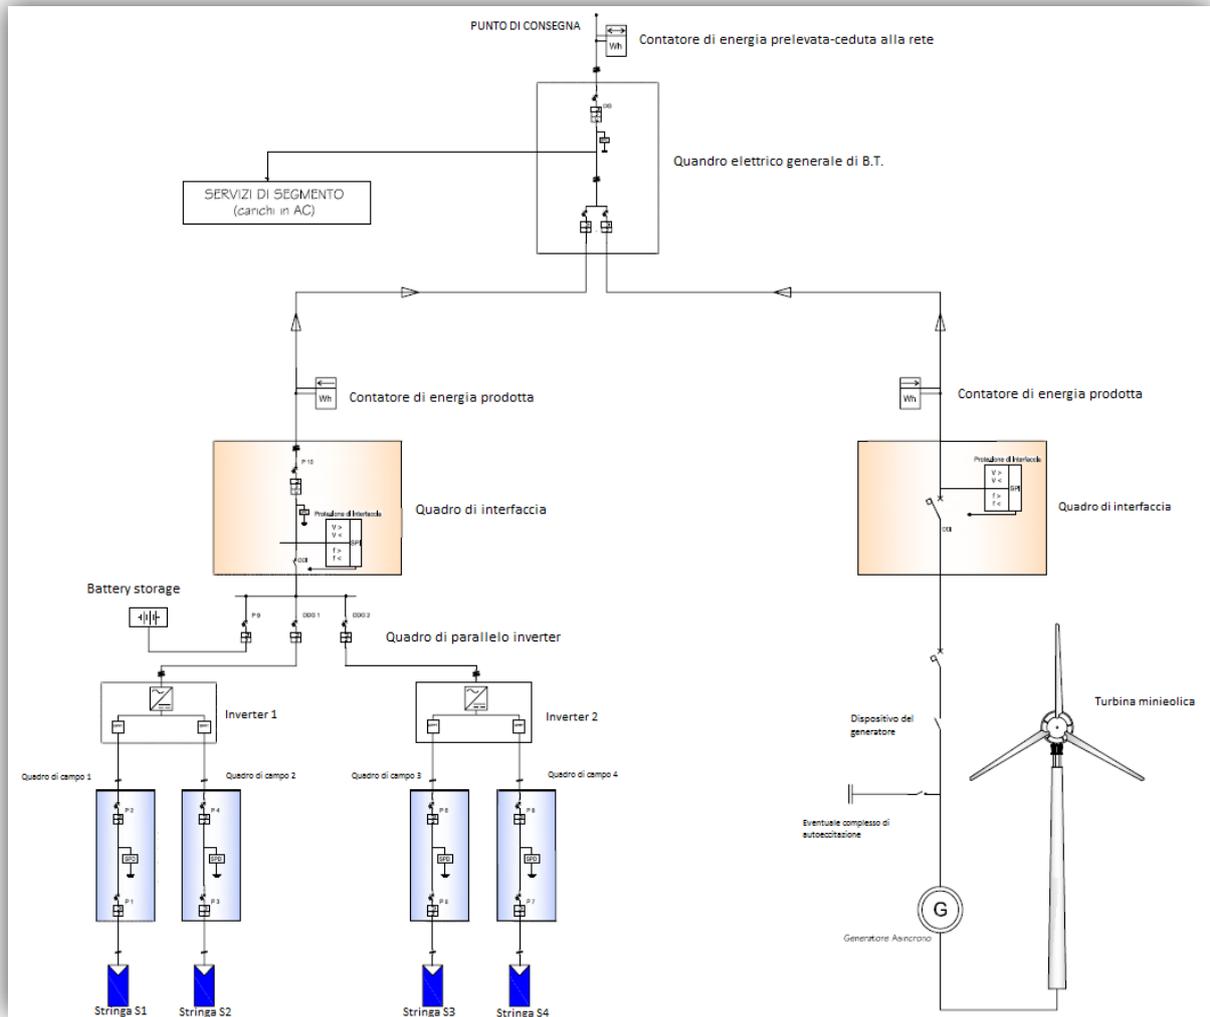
Schema unifilare connessione impianti di generazione alla rete
